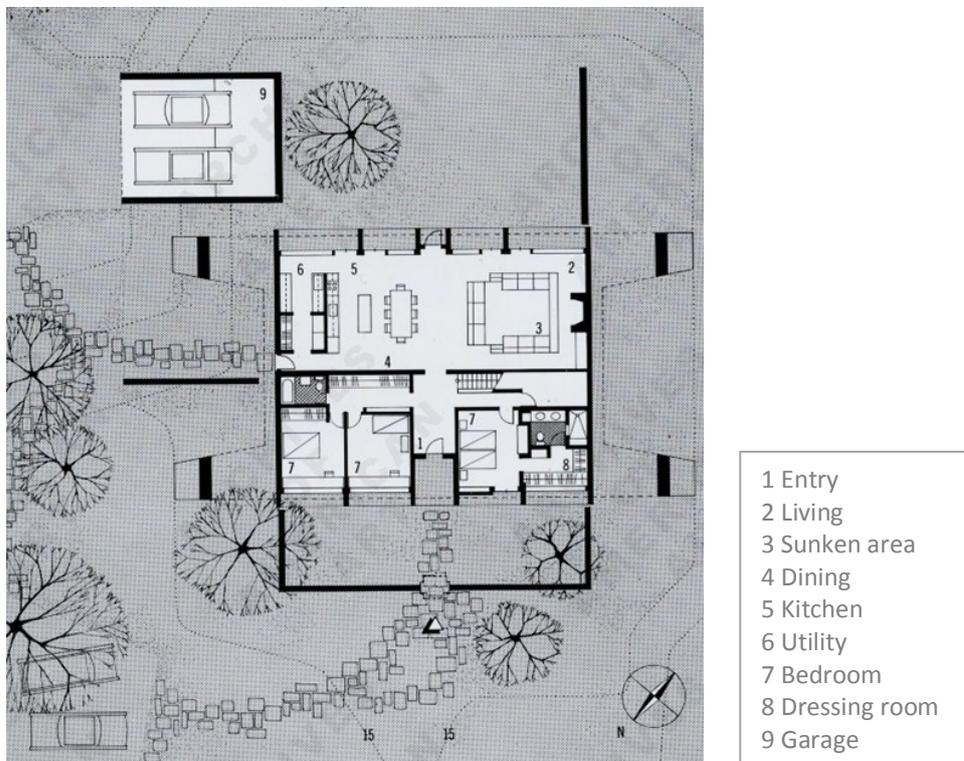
Geller House II, Grundriss, Quelle: www.aaa.si.edu
